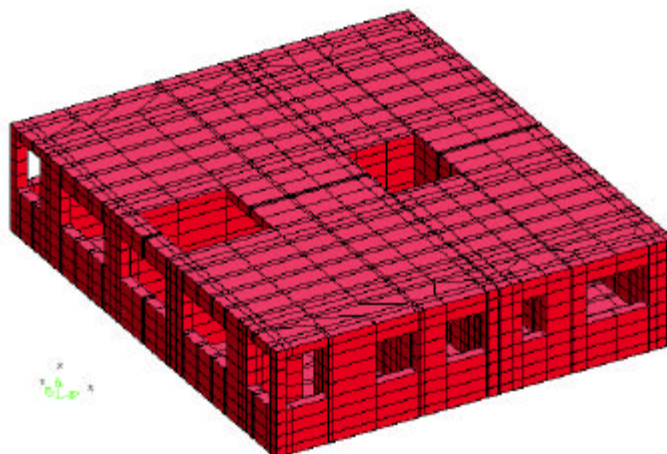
Planta de un edificio de viviendas. Discretización en elementos finitos.
